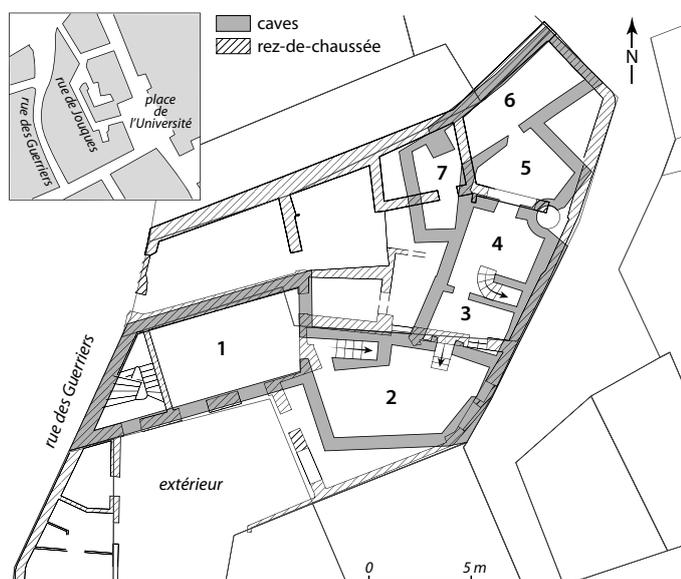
AIX-EN-PROVENCE, IEP, rue des Guerriers. Superposition du plan des caves et du rez-de-chaussée (DAO M. Panneau / DAVA).
